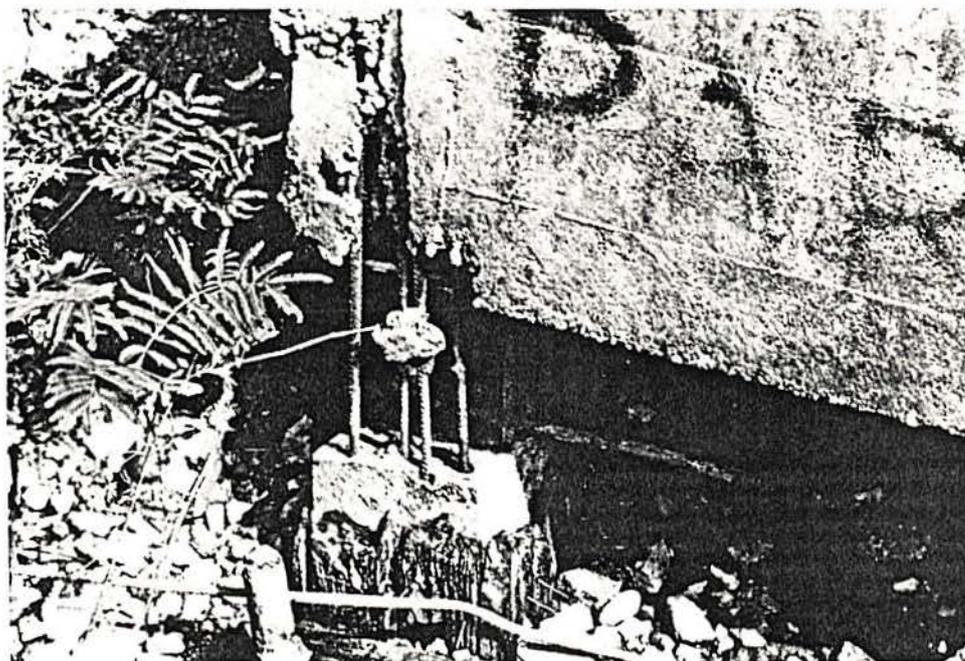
Segregação e ninho de concretagem na ligação pilar/viga de um trapiche
